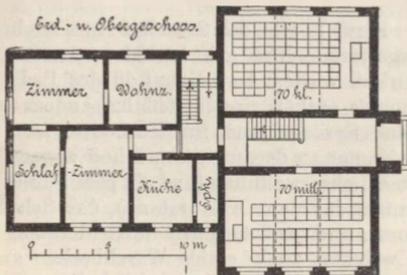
Grundriß einer zweiklassigen preußischen Landschule.
